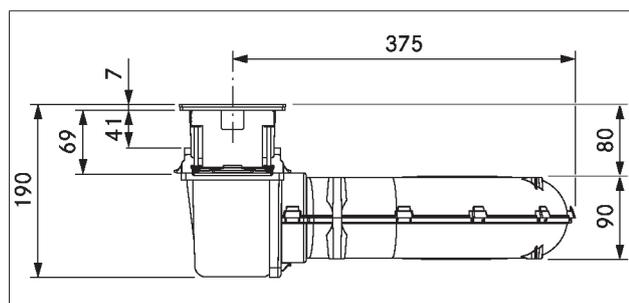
Dimensions CKA2/CKA2AB - Vue de devant
